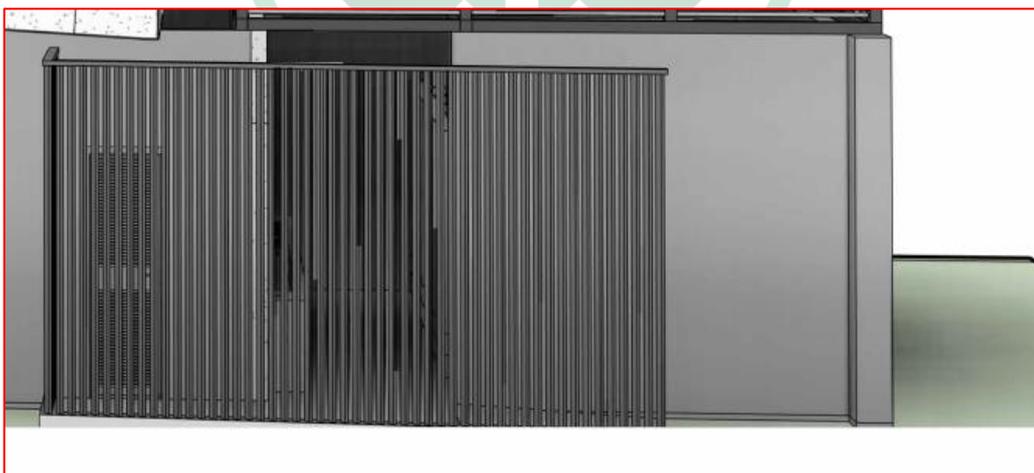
Detalhe em vista de Brise Metálico Vertical – Fonte: CEASA/PR e AUEN
